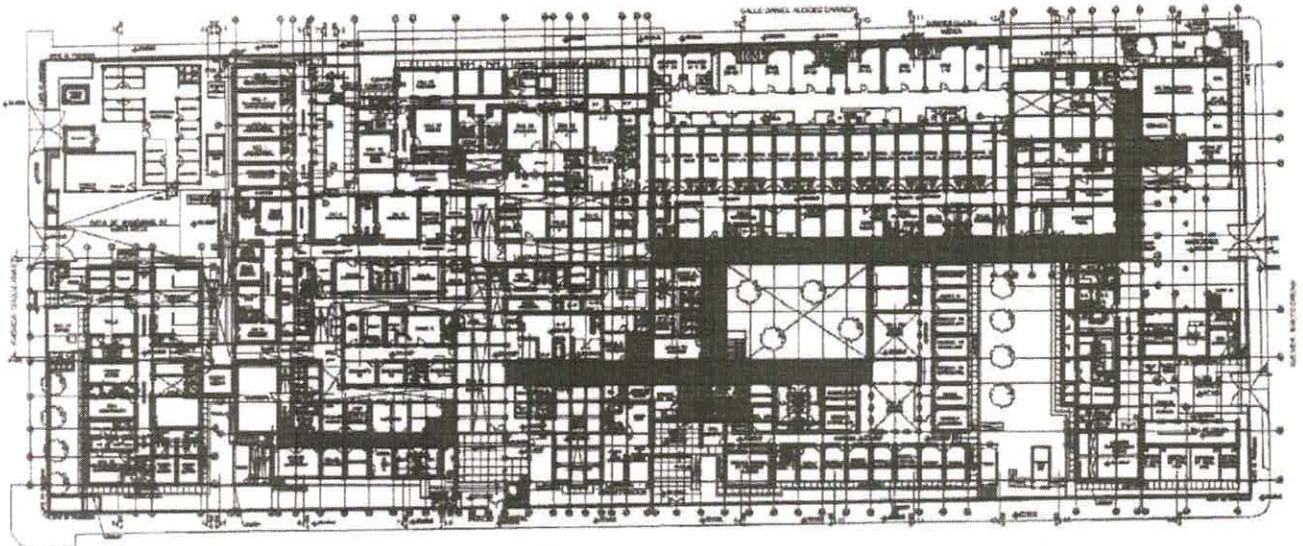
Vista en planta de las instalaciones de los corredores del HAPCSR II-2
